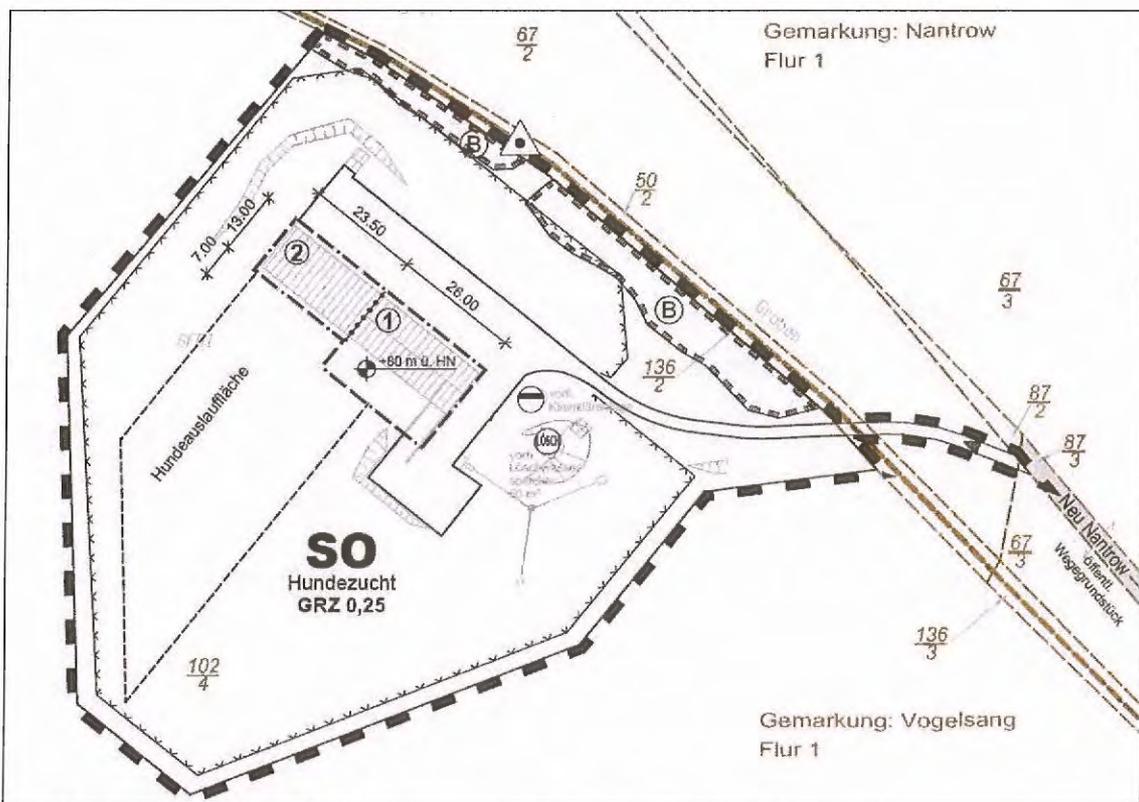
Das Plangebiet im Bebauungsplan (Ausschnitt). Quelle: bab Wismar, 2012.
